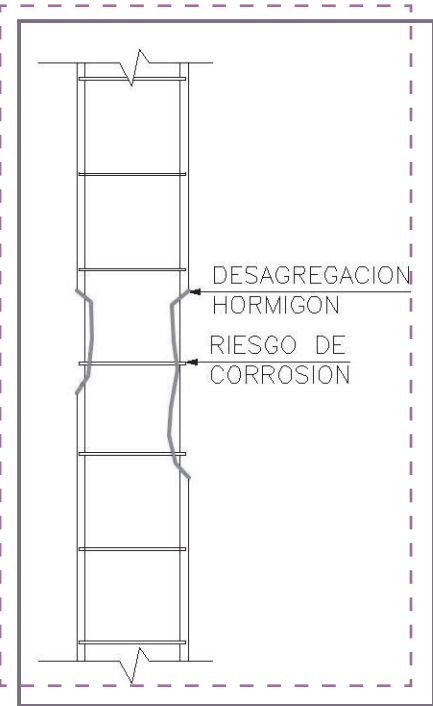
Esquema de la desagregación de un pilar de hormigón armado.
